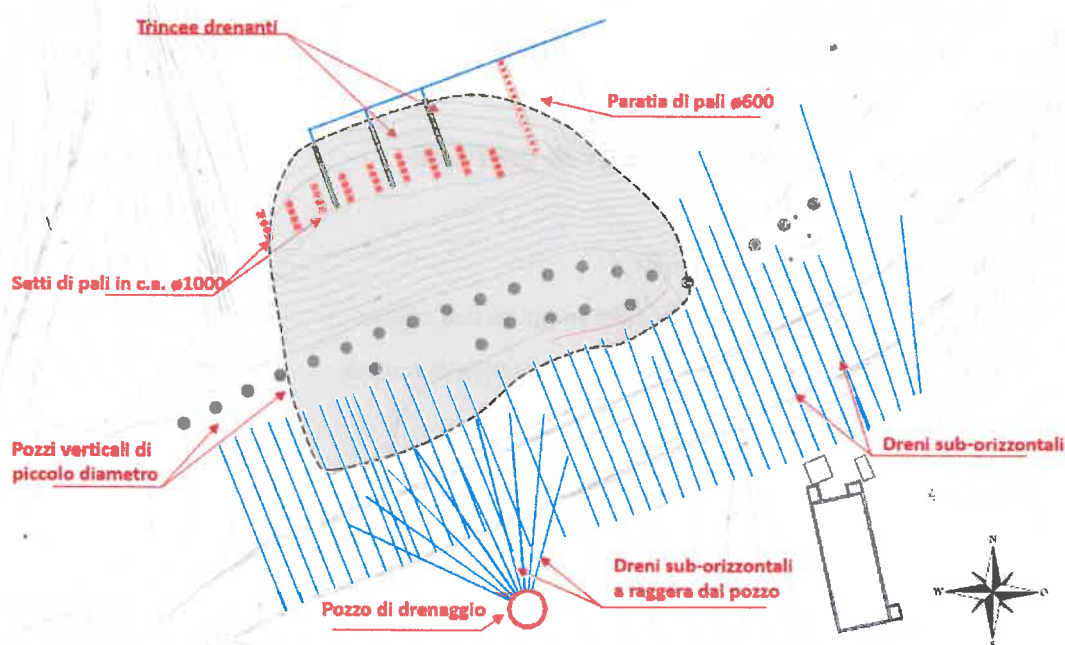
Planimetria dell'area con indicazione degli interventi di consolidamento
